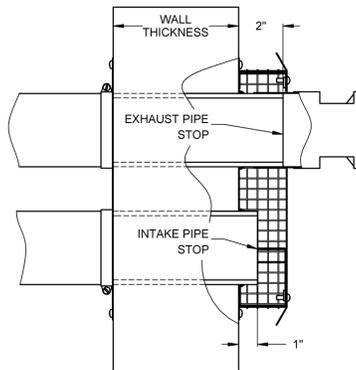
Les conduits traversent complètement le mur (l'illustration montre une installation à la verticale)
